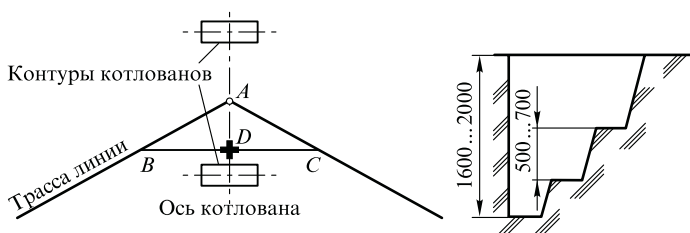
Разбивка котлована под угловую анкерную опору (а) и форма котлована, отрытого вручную (б)
